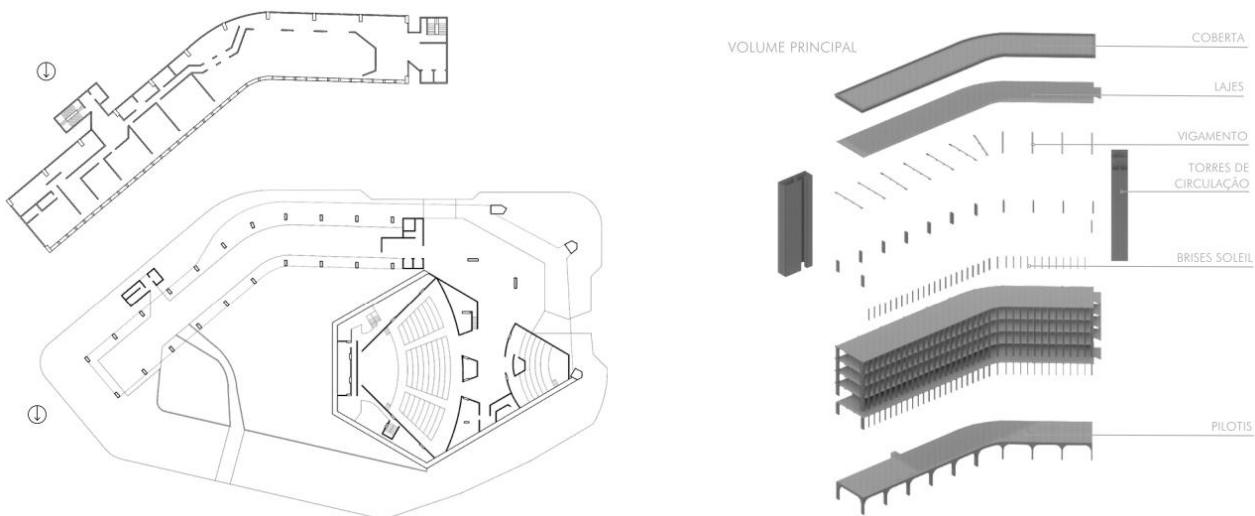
Plantas baixa do térreo e pavimento tipo e Esquema Volumétrico.
